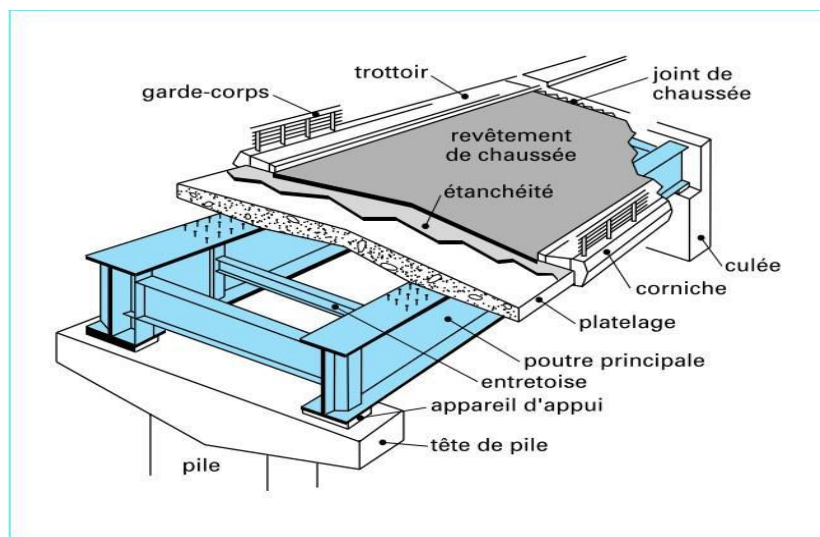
Morphologie d'un pont mixte bipoutre.
